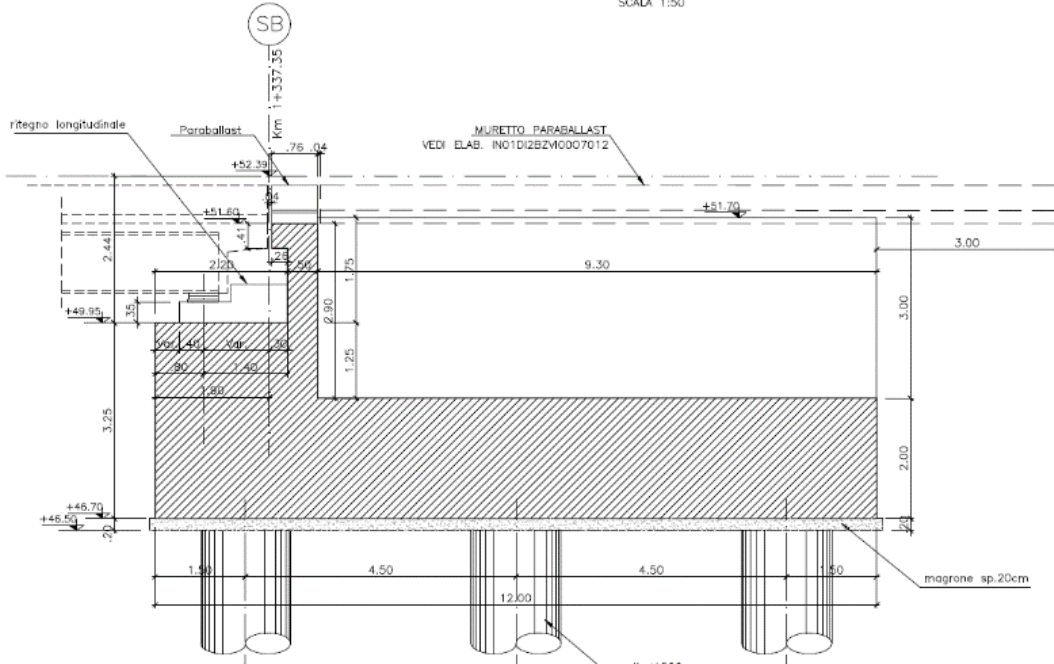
Sezione longitudinale Spalla B
